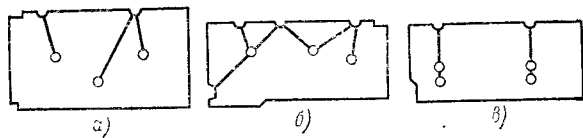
Примеры выполнения каналов в железобетонных панелях перегородок (а и б) и стеновых панелях (в)
